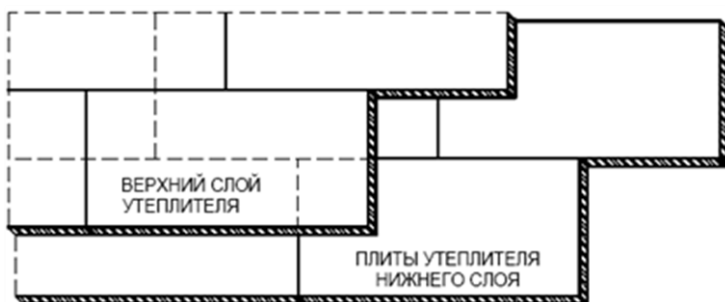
Смещение плит верхнего и нижнего слоев при укладке утеплителя
